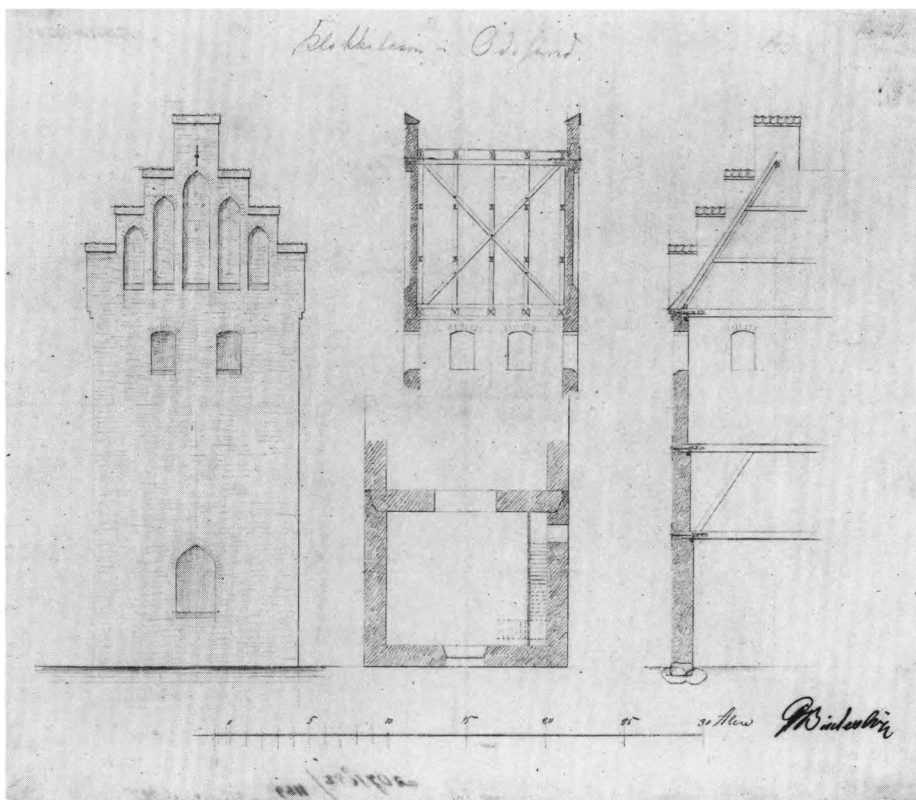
Facade, plan og snit af tårn 1852-53 (s. 2064). 1:200. Projekt ved Gottlieb Bindesbøll. Kunstakademiets Bibliotek. - *Facade, plan and cross-section of the tower 1852-53.
